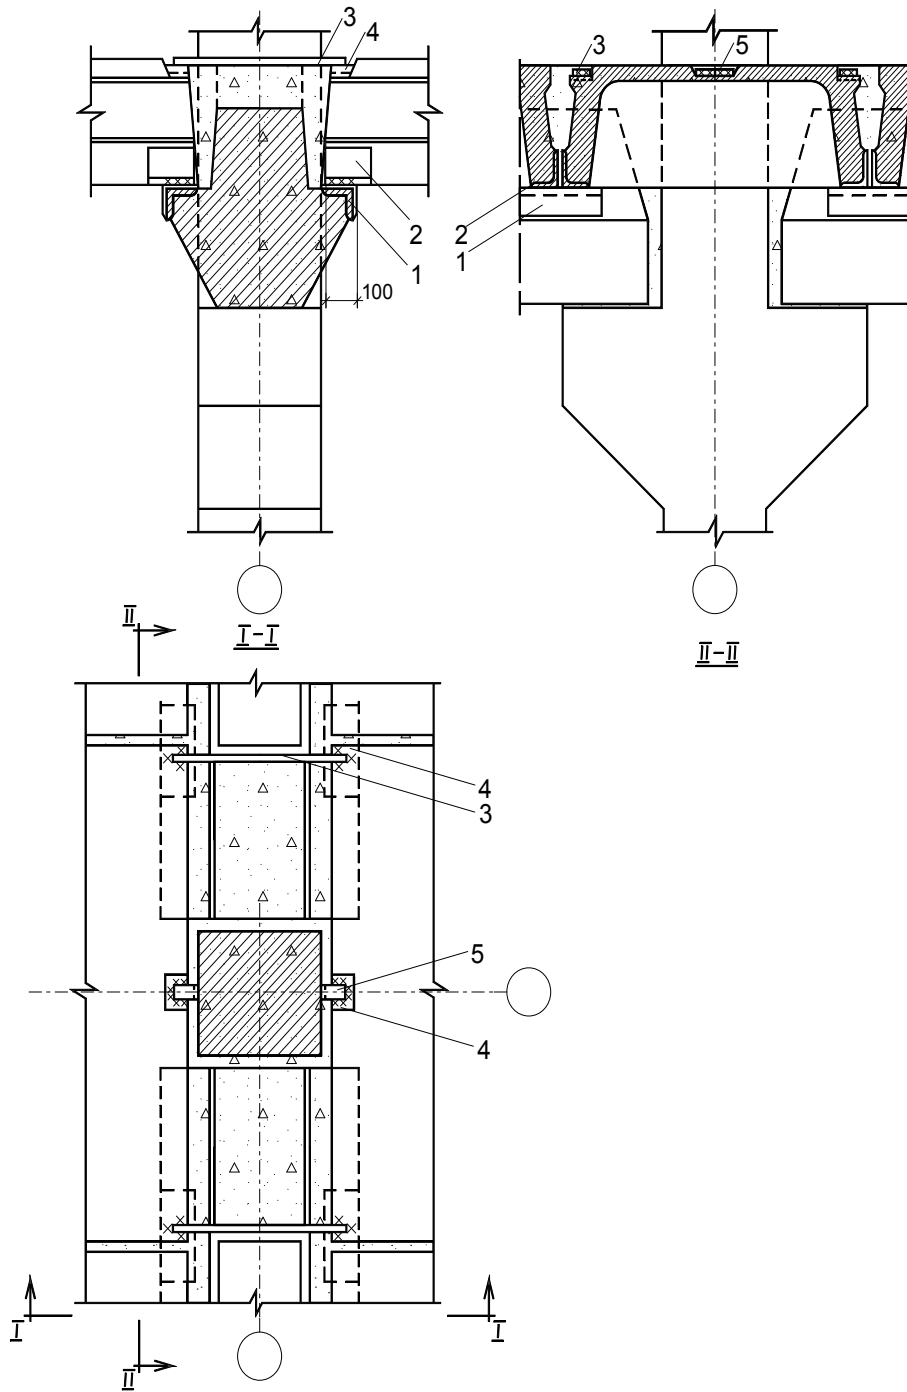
Деталі кріплення плит перекриття біля середньої колони при ригелях з полицями: 1 – закладні деталі ригеля; 2 – закладні деталі плити перекриття; 3 – накладки зі смугової сталі; 4 – верхні закладні деталі плит; 5 – коротиші з прокатного кутика, приварені врозпір з колоною
